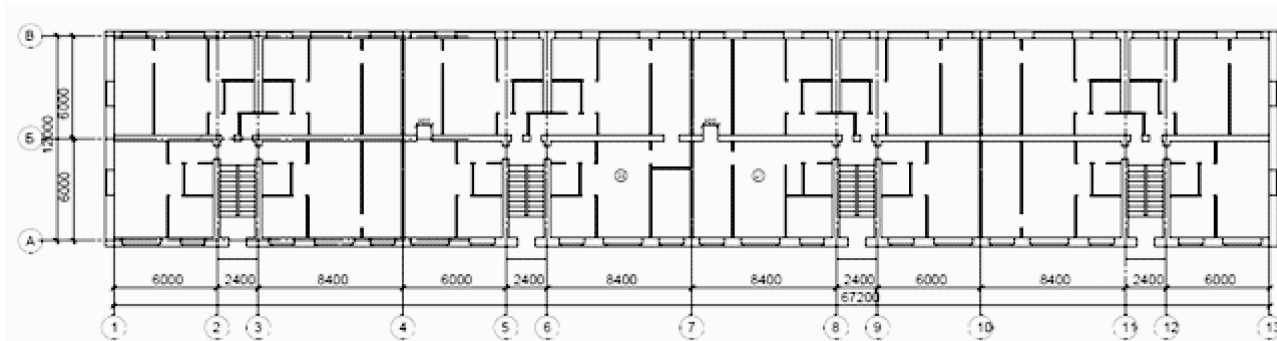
План типового поверху житлового будинку по вул. Толстого, 122, в м. Чернігів
